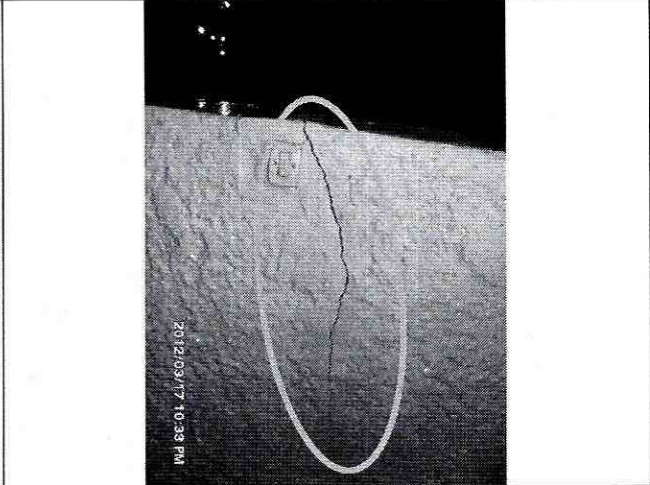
Se observan fisuras con tendencia vertical en muros del tanque de almacenamiento de agua potable.
